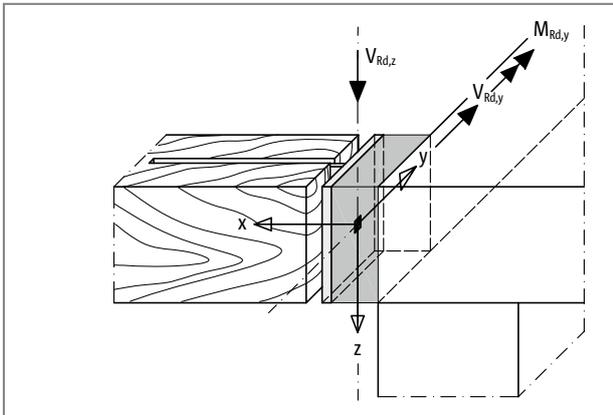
Schöck Isokorb® T Typ SK mit Stahlschwert: Vorzeichenregel für die Bemessung
